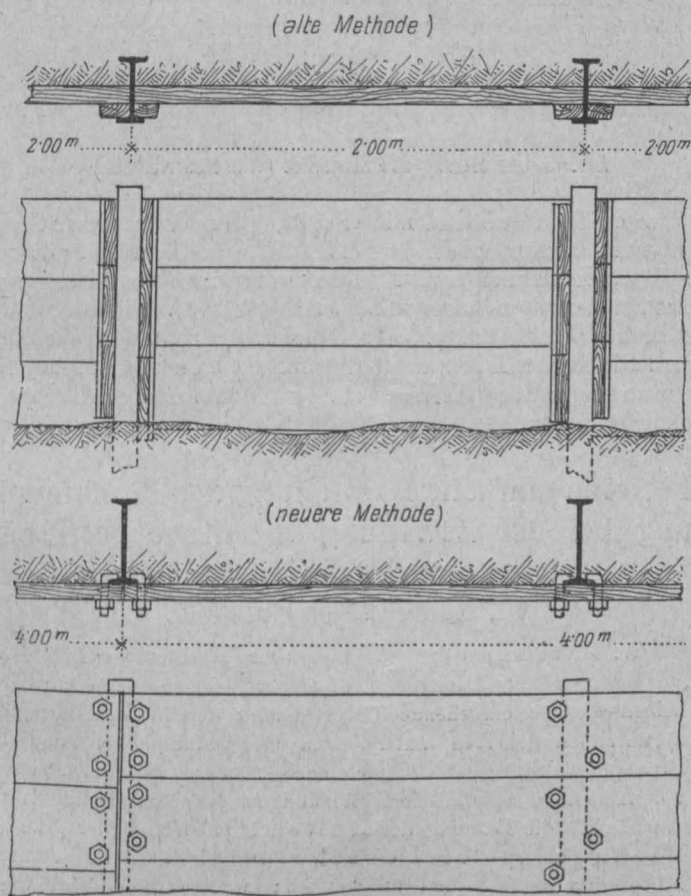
Grundriß und Ansicht der Baugrubeneinschalung
